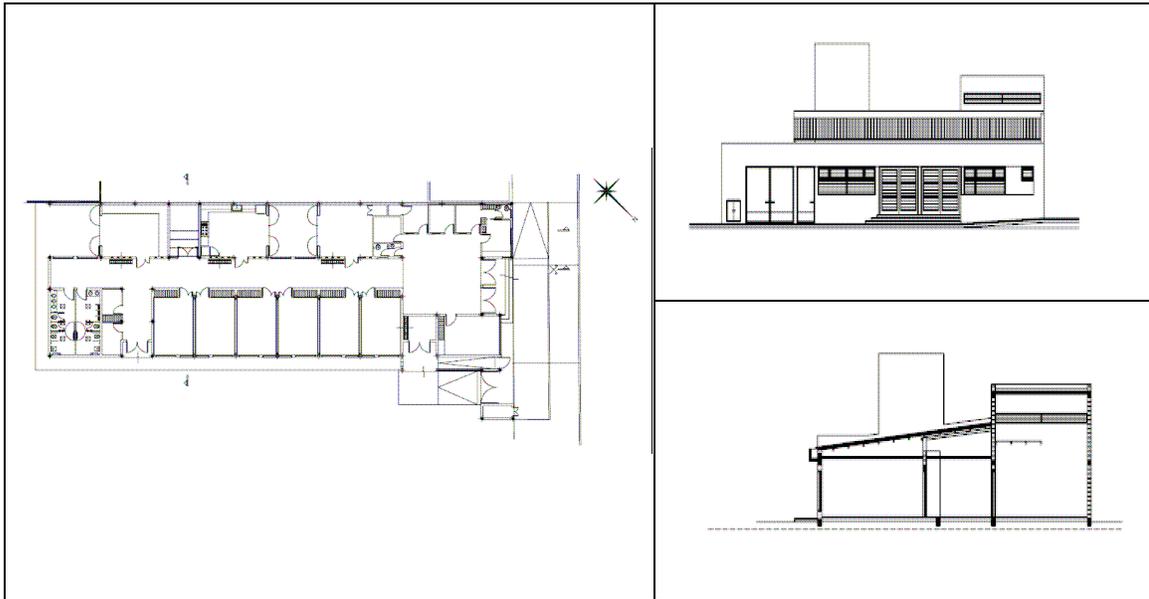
Planta, corte y vista de la E.E.E. N° 507
